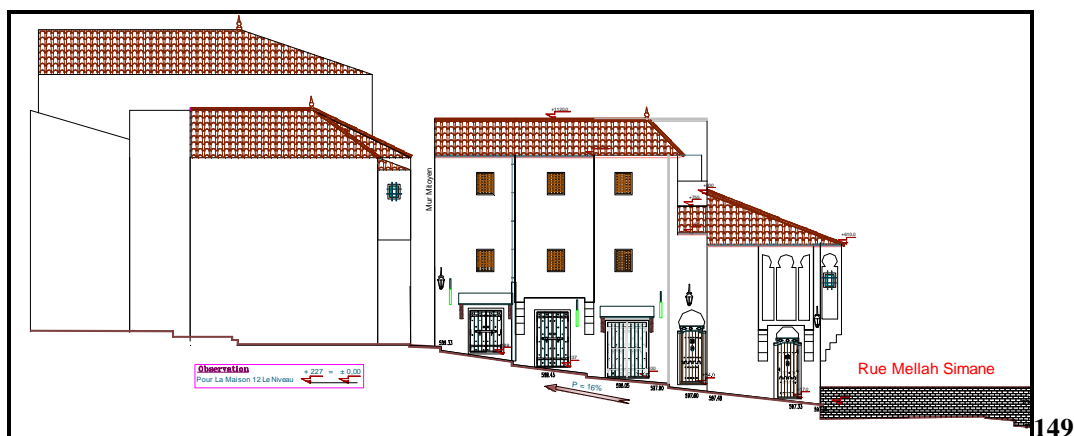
Façade sur placette de la maison 19 et 19 bis.
